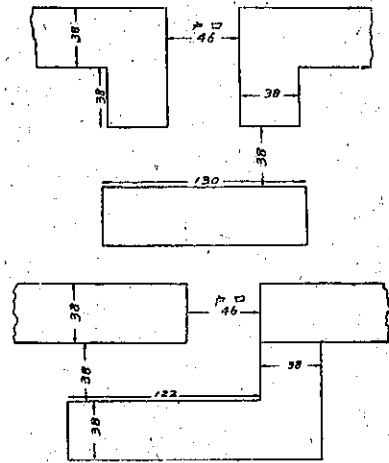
(ロ) 無筋コンクリート造小型防護室平面, 断面圖
